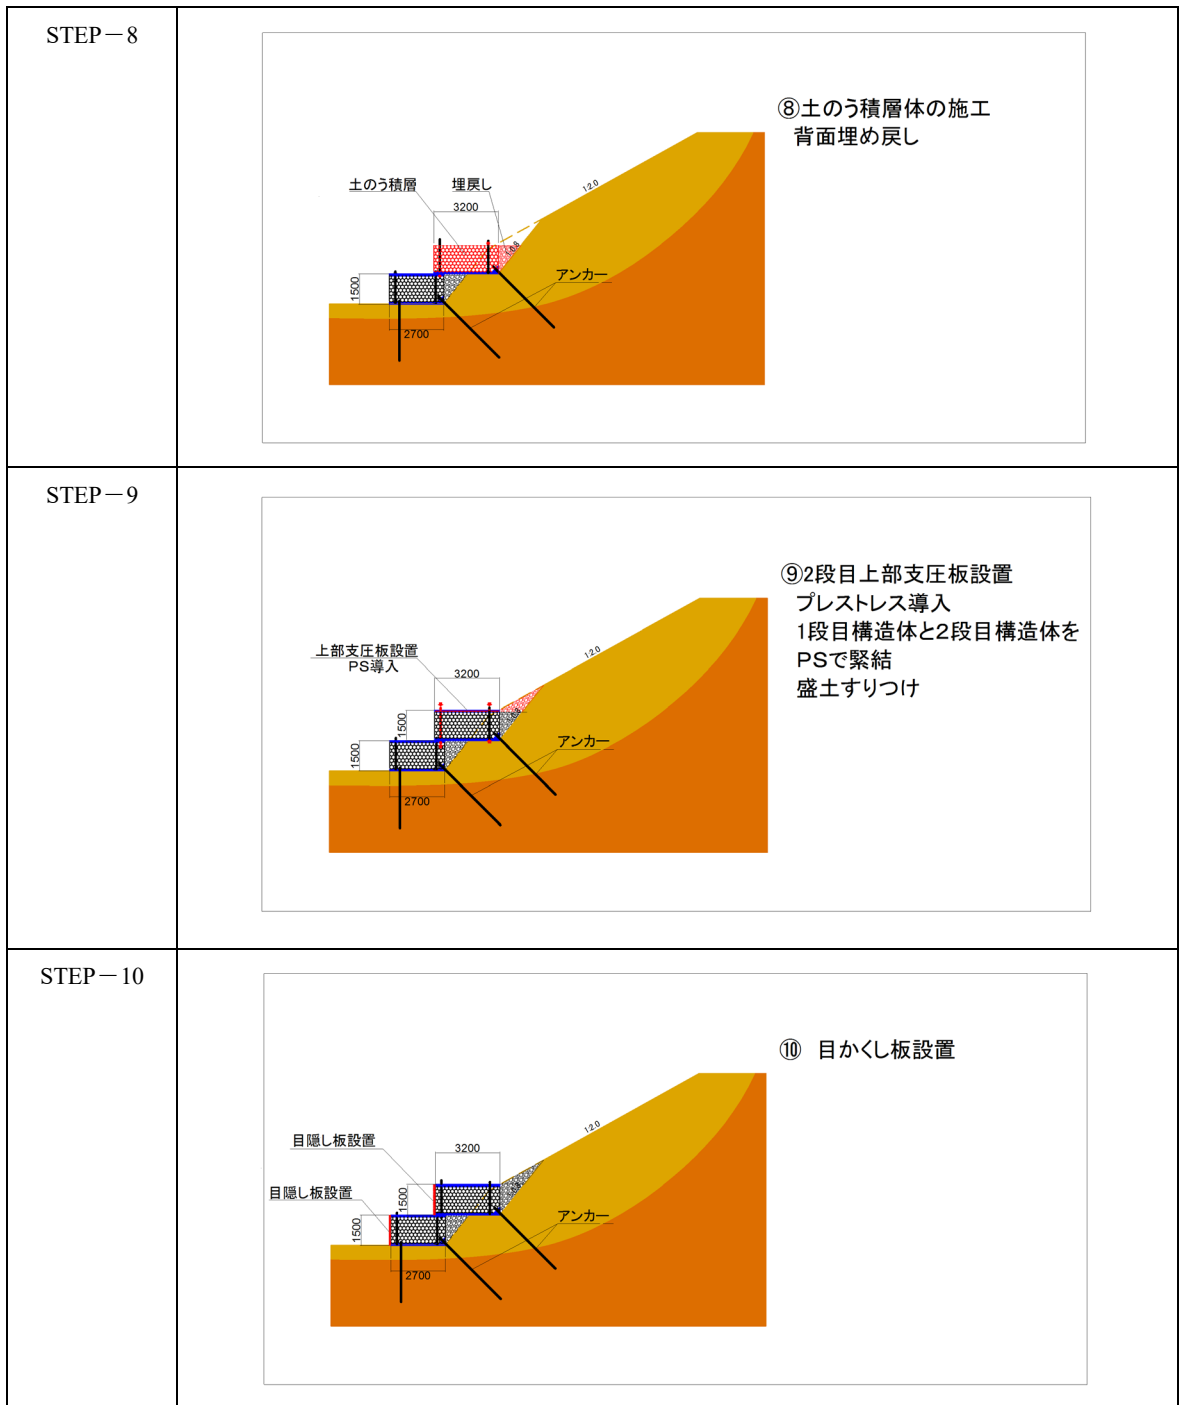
(c) 「多段式」盛土法先補強工法の施工順序図（その3）
